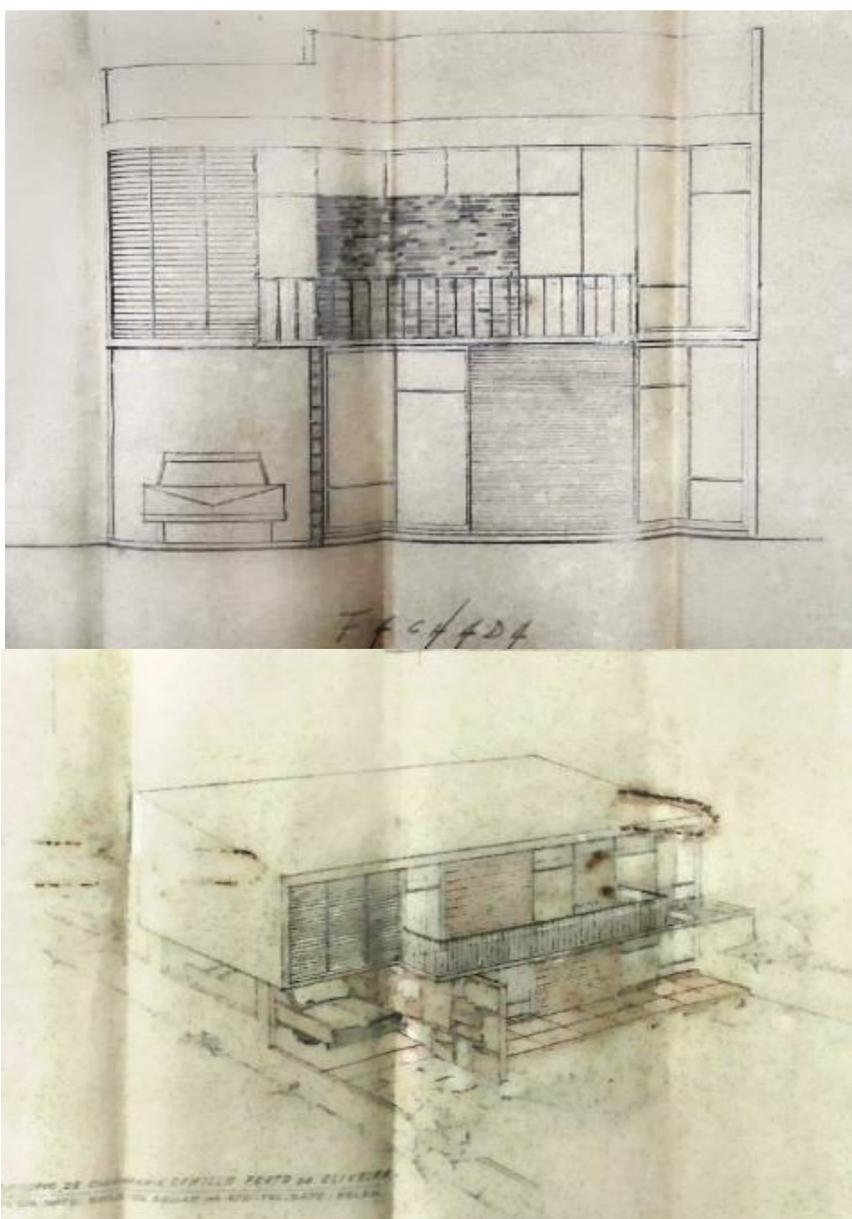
Fachada e Perspectiva da Casa Davina Monteiro. Fonte: Acervo LAHCA.
